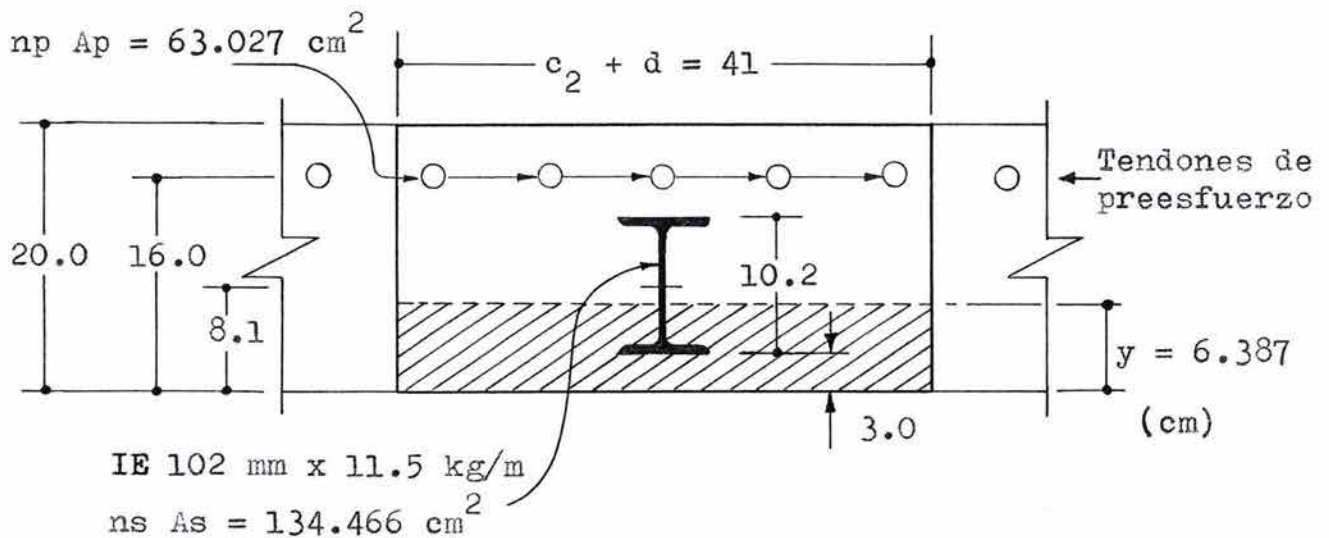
DISEÑO DE UN CABEZAL PARA CORTANTE: SECCION TRANSVERSAL EFECTIVA DE LA FRANJA DE LOSA.
